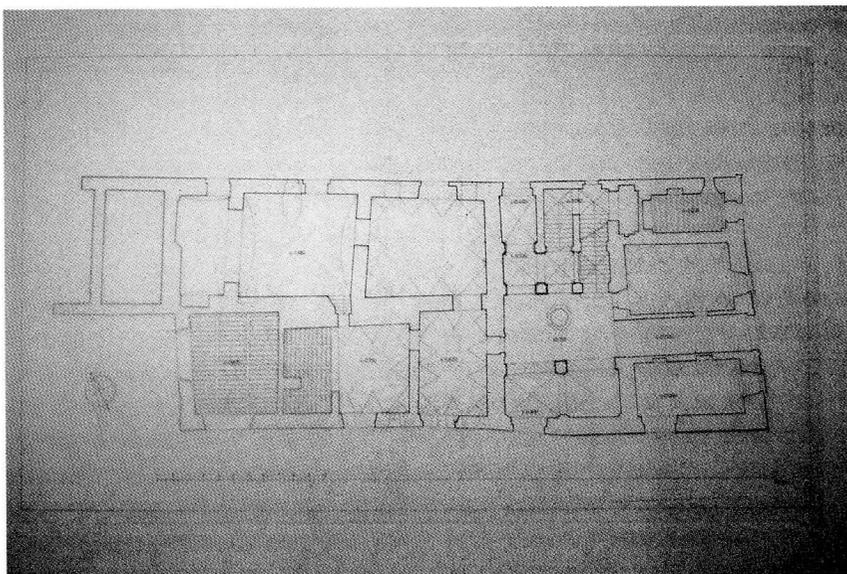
Pianta piano terra, *ante* ultimi interventi.
